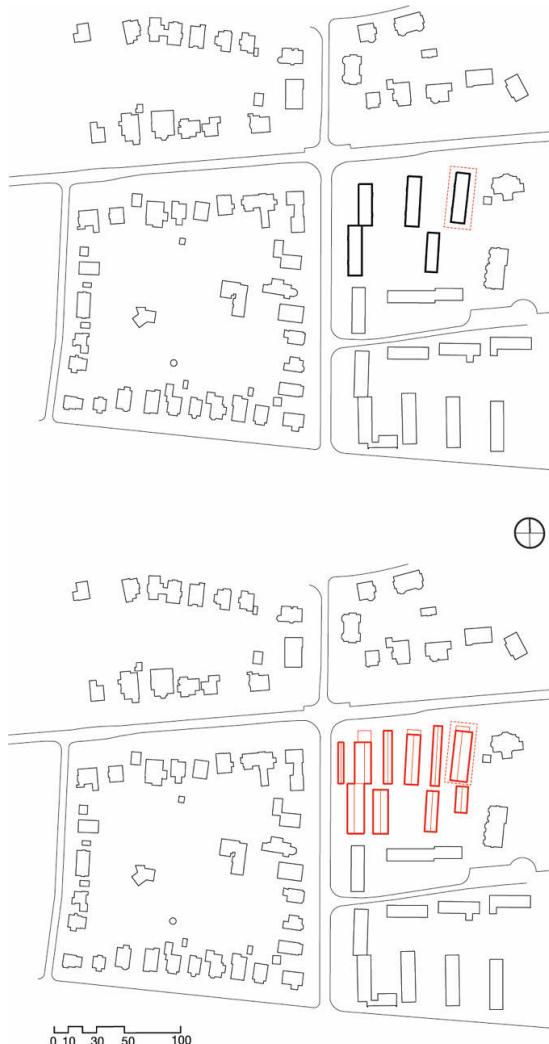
Lagepläne Bestand – Nachverdichtung, Bergedorf
